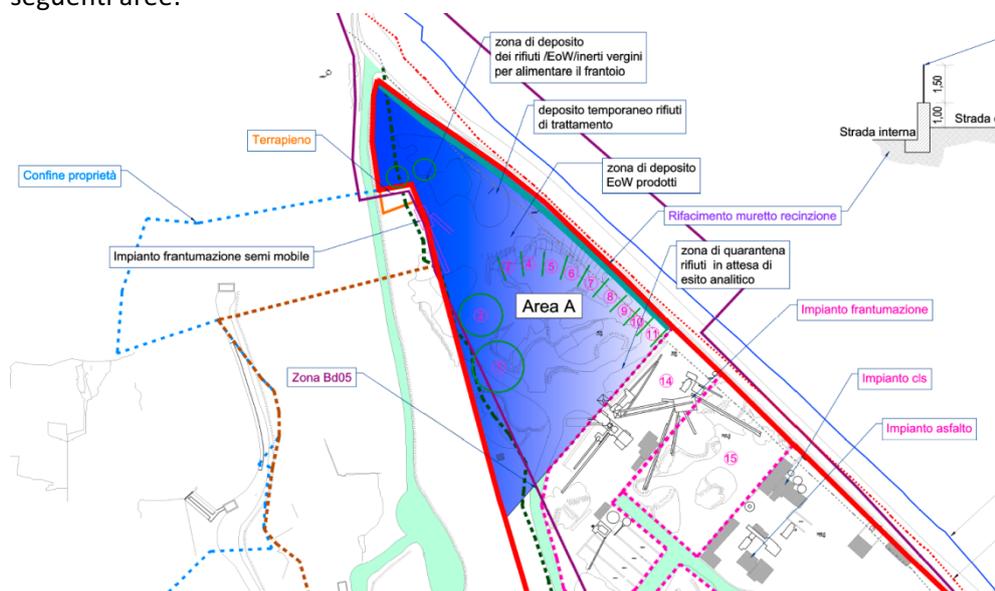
Planimetria Impianto con aree trattamento rifiuti
